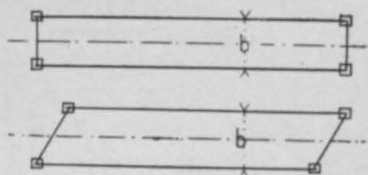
Grundriß der geraden und der schiefen Brücke.
